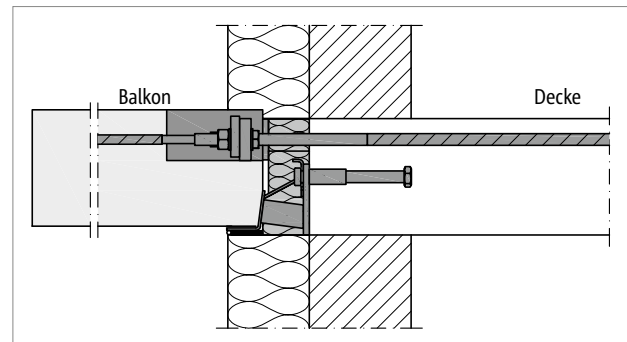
Schöck Isokorb® IQ Typ K-B: Anschluss Fertigteilbalkon mit balkonseitiger Verschraubung; die Deckenhöhe entspricht der Höhe des Schöck Isokorb®
